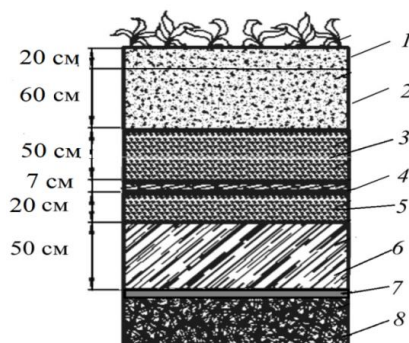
Конструкция комплексного перекрытия ОРО:
